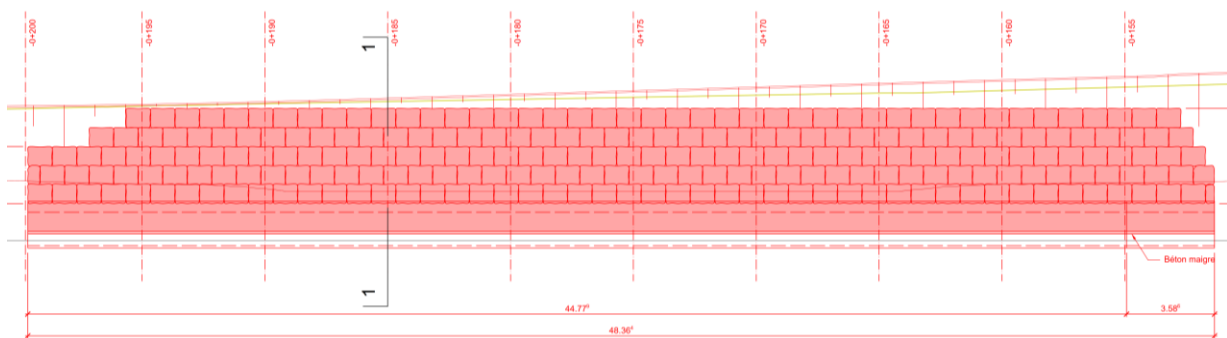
Elévation longitudinale du Mur de la Gérine, km -0+200 à km -0+155
